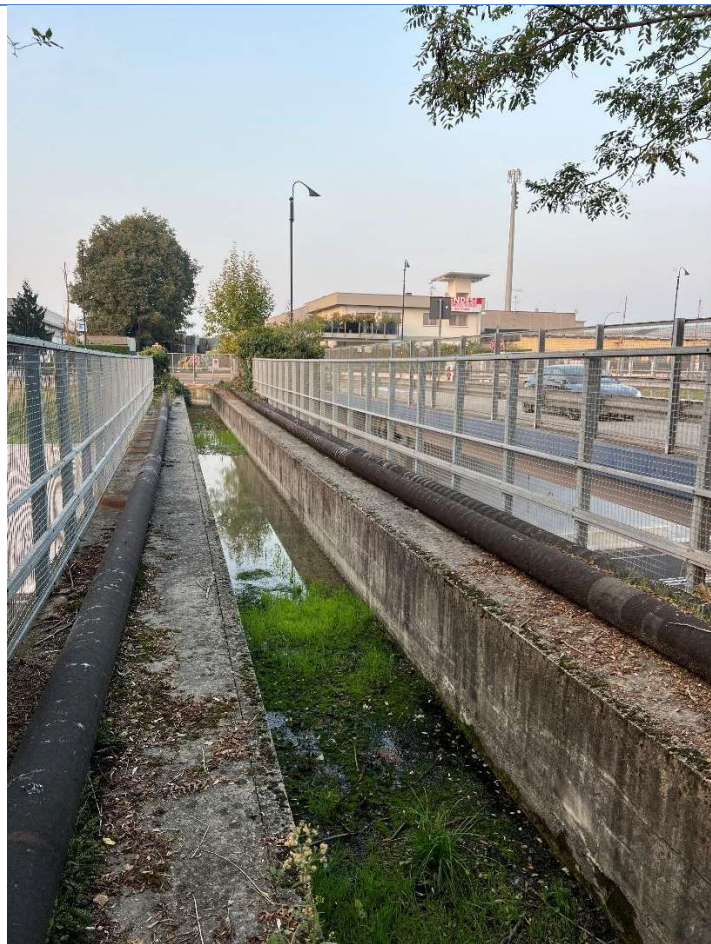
vista attraversamento con ponte canale della Nuova Cassanese da valle
